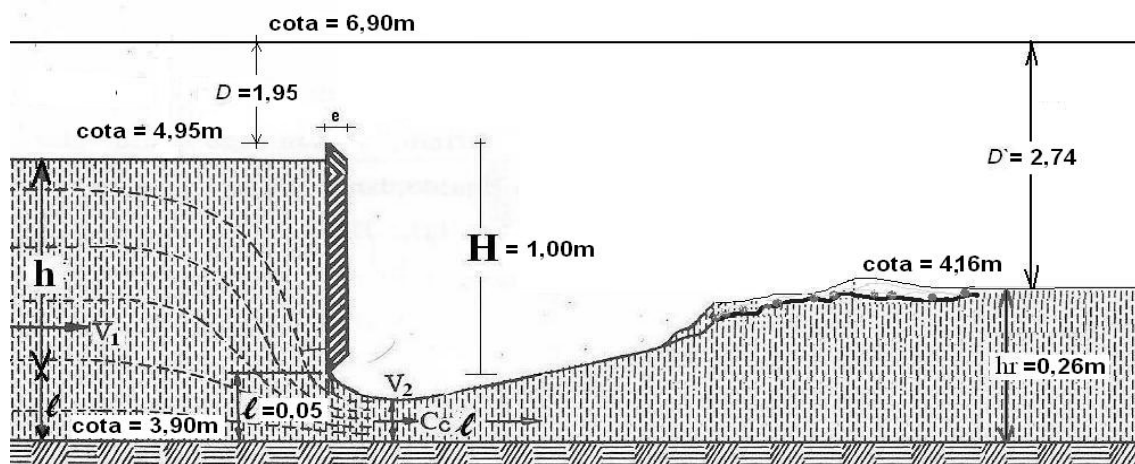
14 - Detalhes do corte da viga de retenção no Canal dos Bultrins (Fonte: o autor).
